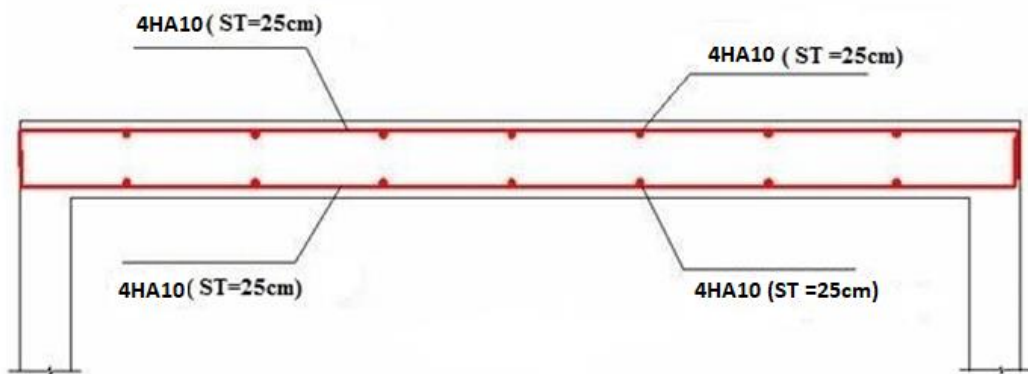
plan de ferrailage de la salle machine suivant x-x.
